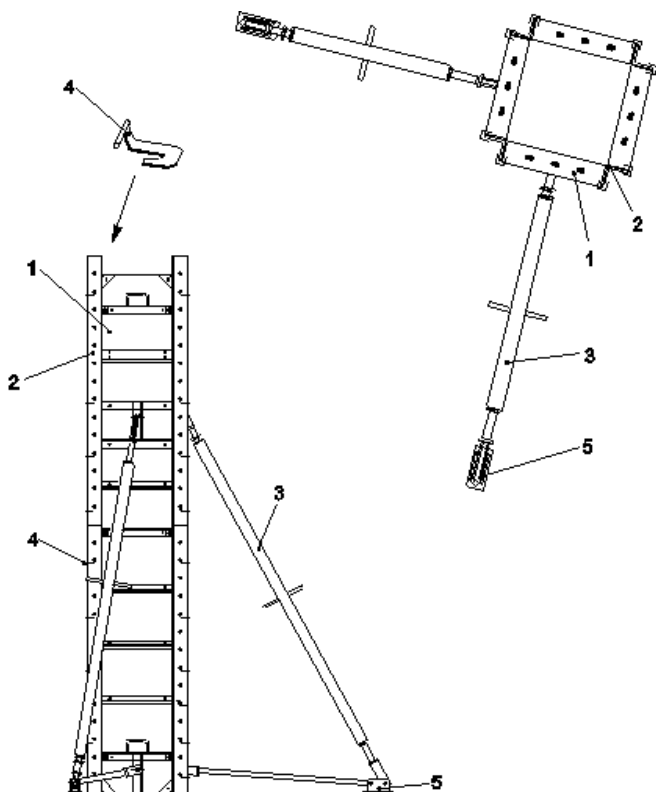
Схема устройства опалубки прямоугольных колонн из щитов МОДОСТР-КОМБИ:
